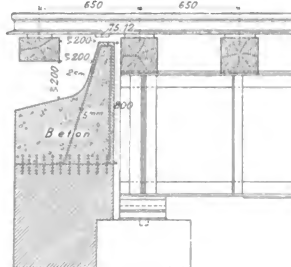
bis 305. Walzbalkenbrücke. M. 1 : 40.
